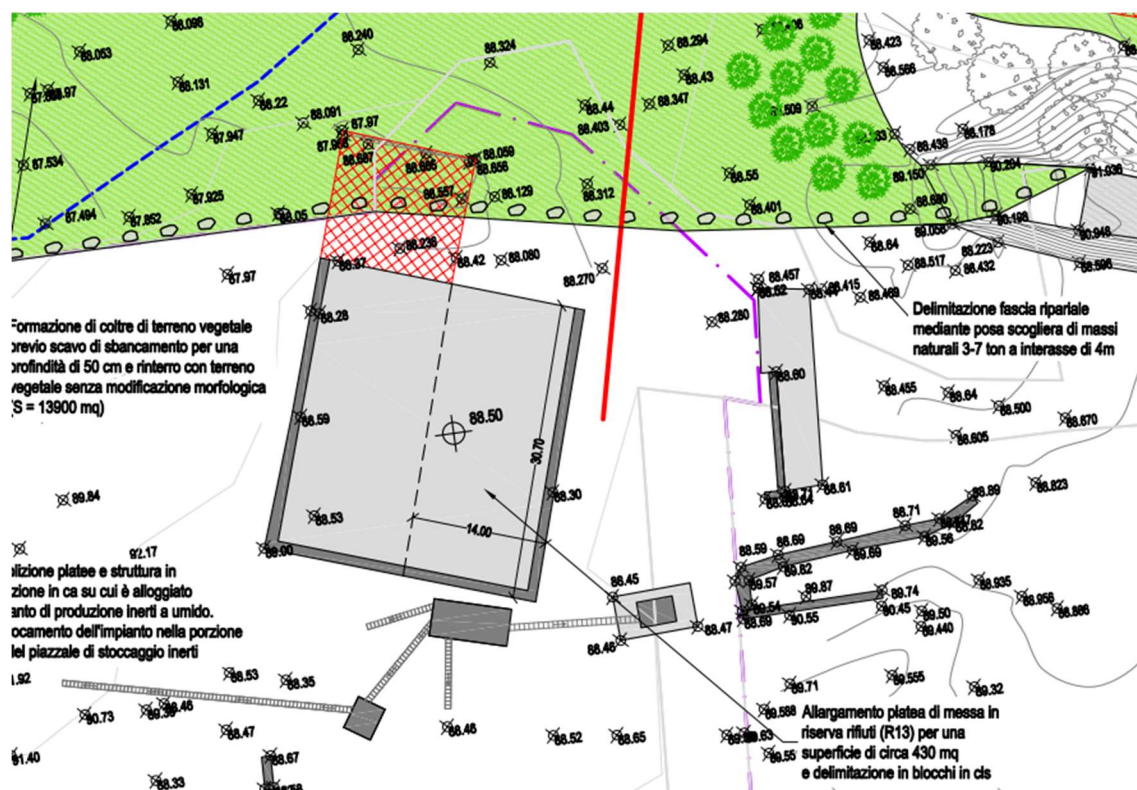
Estratto tavola 2A Planimetria di Progetto Stato Variante Stralcio 1 dove si evidenzia la rimozione di parte della platea di messa in riserva (R13) e l'ampliamento della stessa
